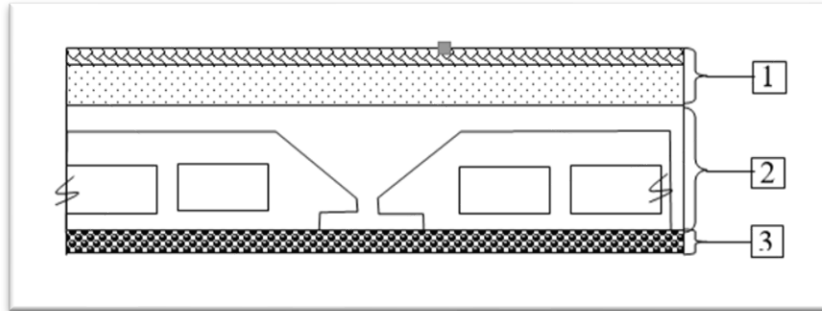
Coupe transversale d'un plancher à corps creux (étage courant)
